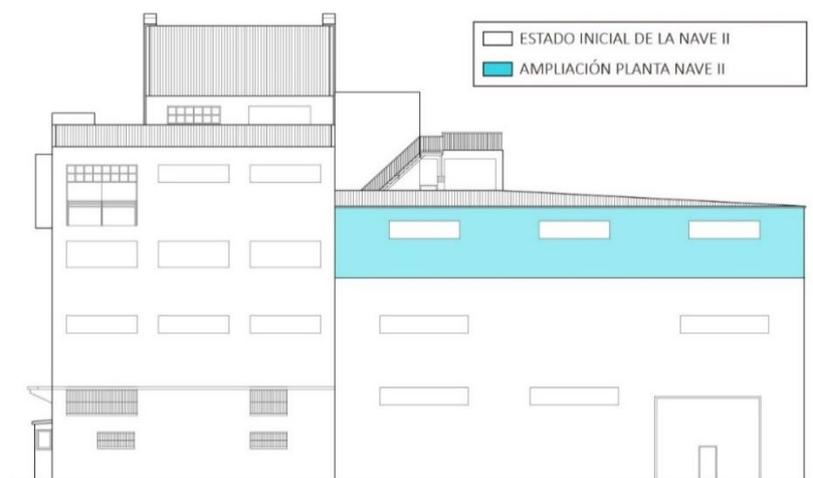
Esquema de fachada alzado de la adición de una nueva planta en la nave II. Fuente: elaboración propia.
